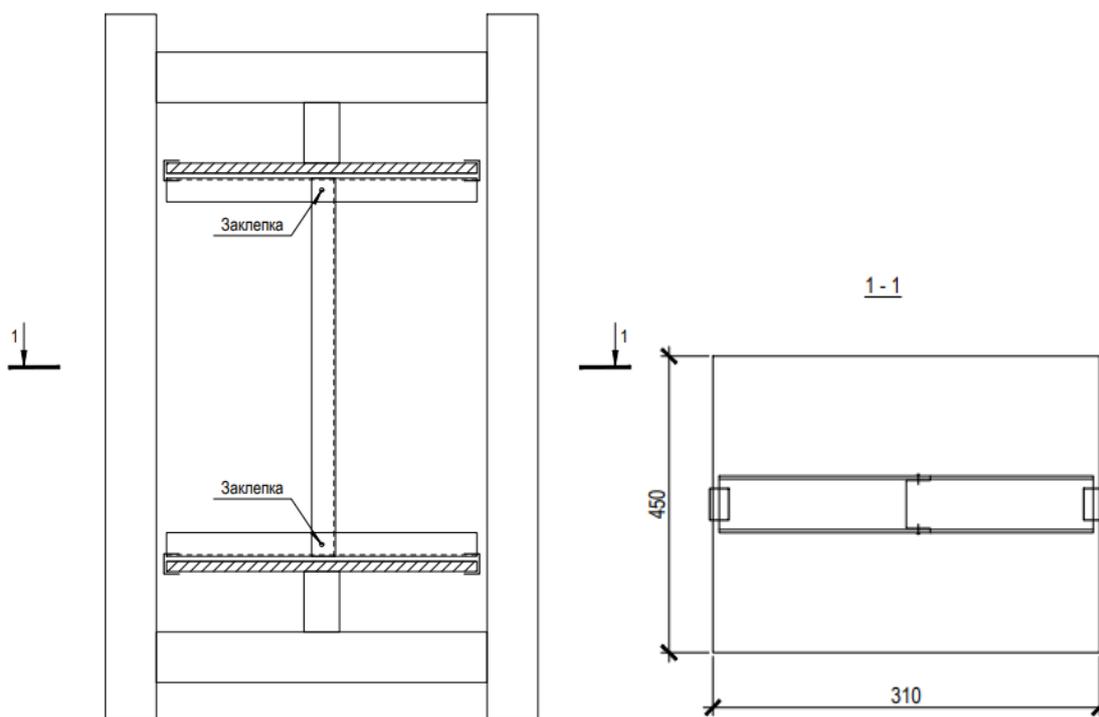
Схема испытания узловых сопряжений ЛСТК на сжатие
